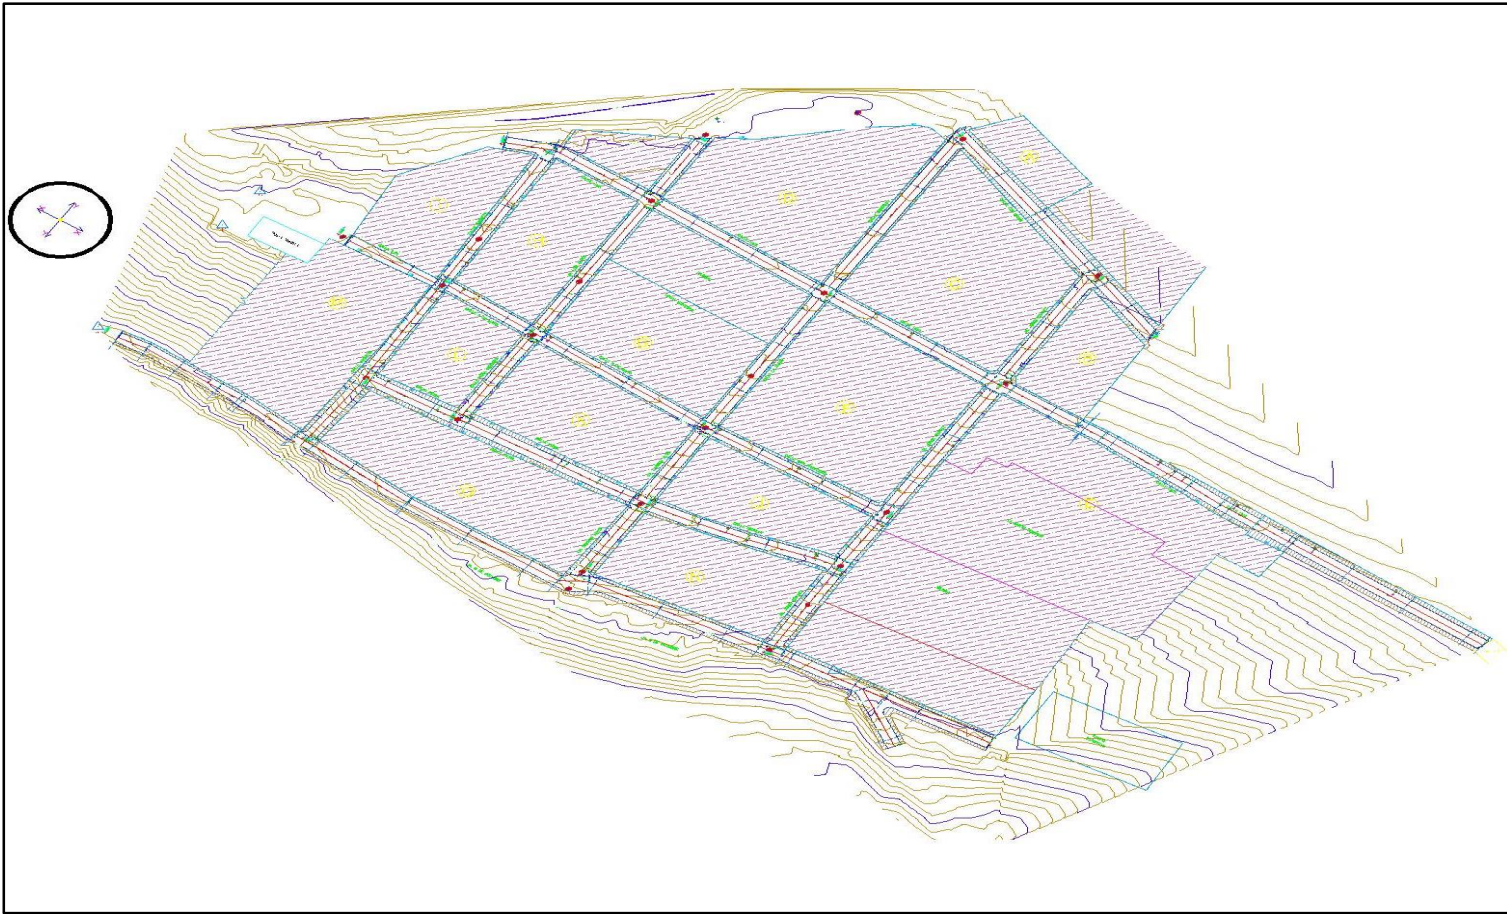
C: Plano General de Proyecto de Creación de Pistas y Veredas del Distrito de Allauca, Yauyos, Lima.
